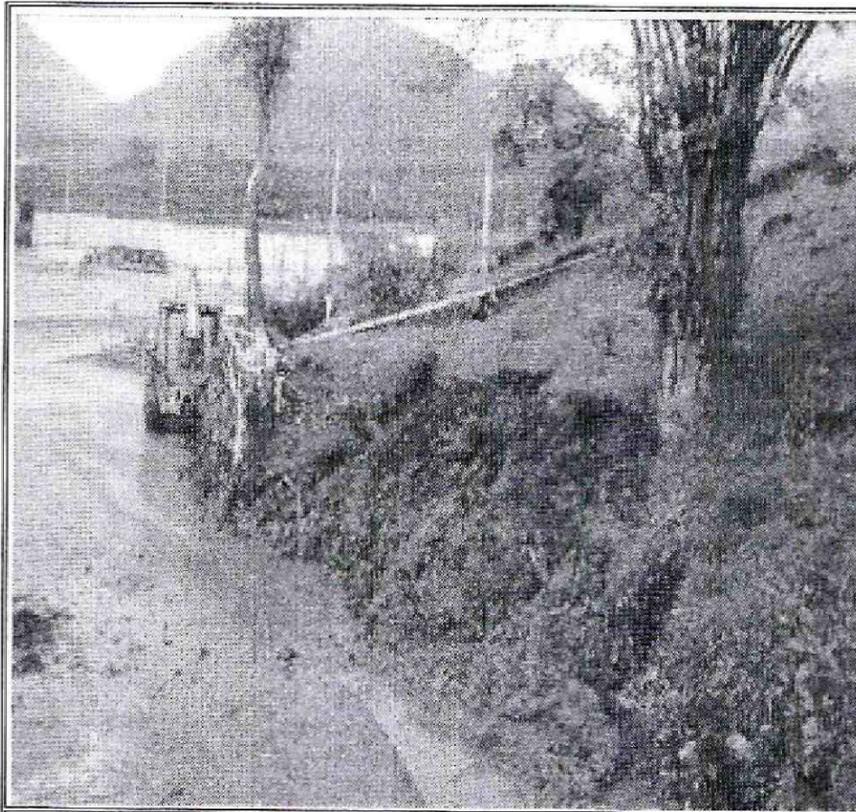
Grietas en el talud rocoso sobre el Costado Sur del predio de la Calle 1 No. 1 A – 30 Barrio Buenos Aires
